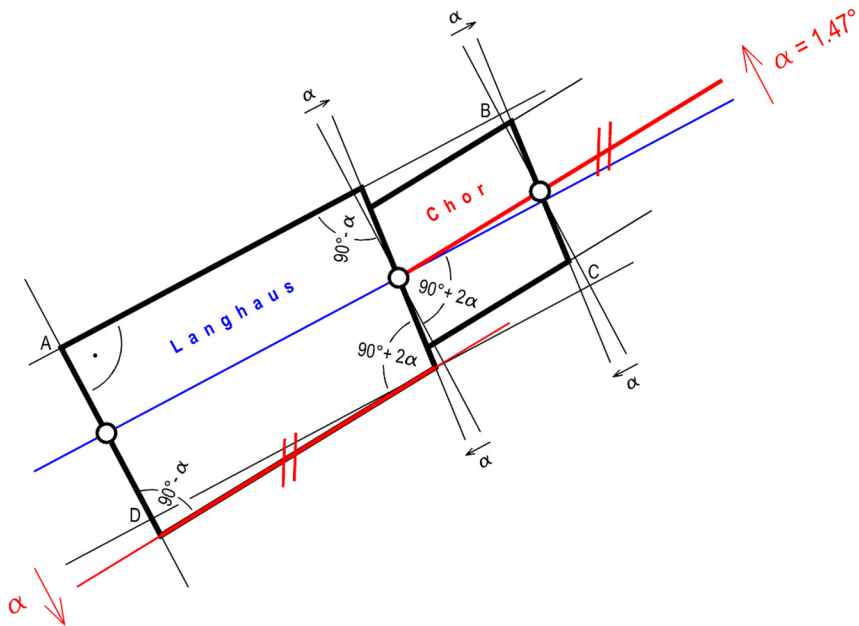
Pfarrkirche Fischau, rekonstruierter Grundriss mit Winkelabweichungen vom Grundrechteck A-B-C-D (schematische Darstellung, Winkel α überhöht)
